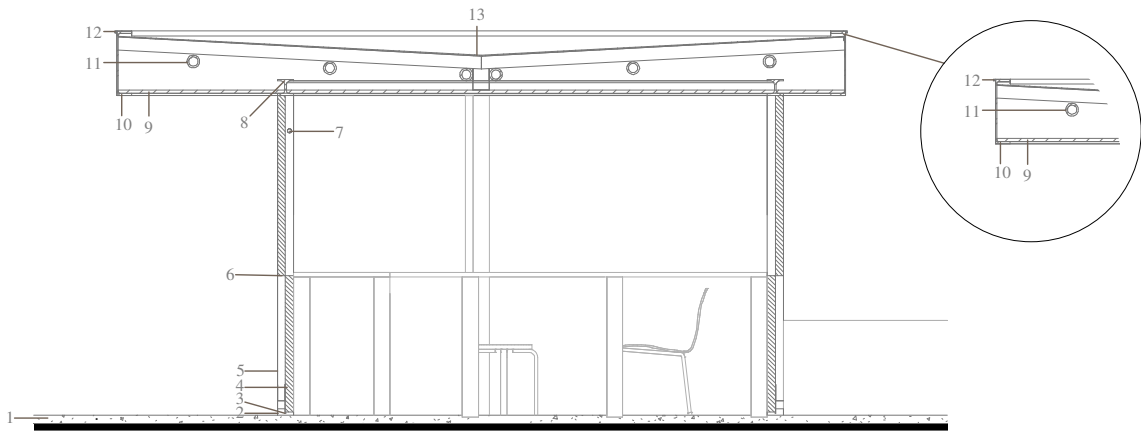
Planta Arquitectónica fuente: propia elaboración: William Marquez
